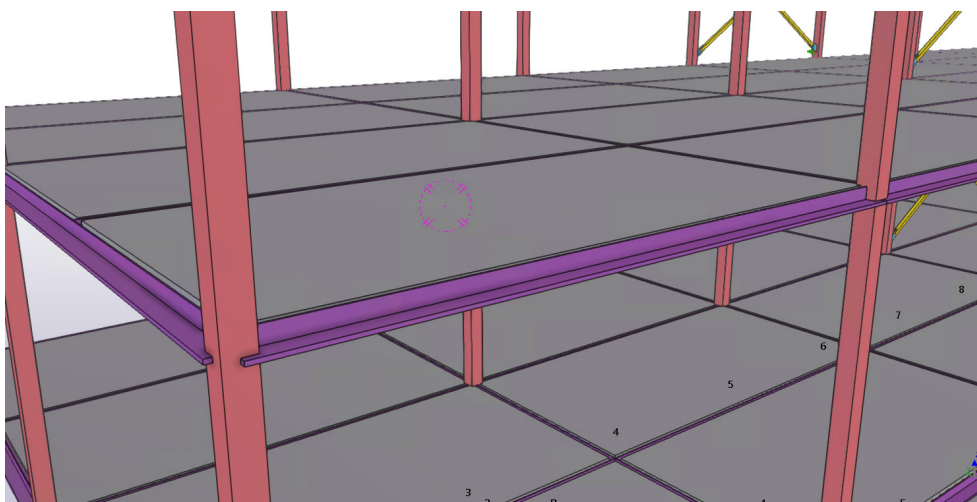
Внешний вид сталежелезобетонного перекрытия, опертого на балки
